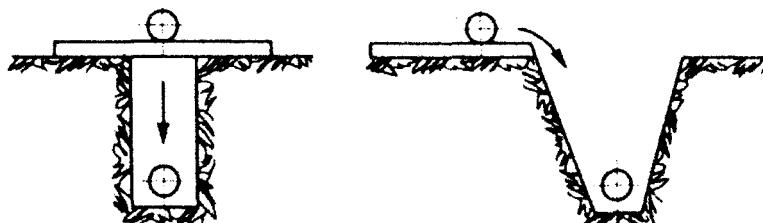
Монтаж трубопровода над траншееей и с бровки траншеи
